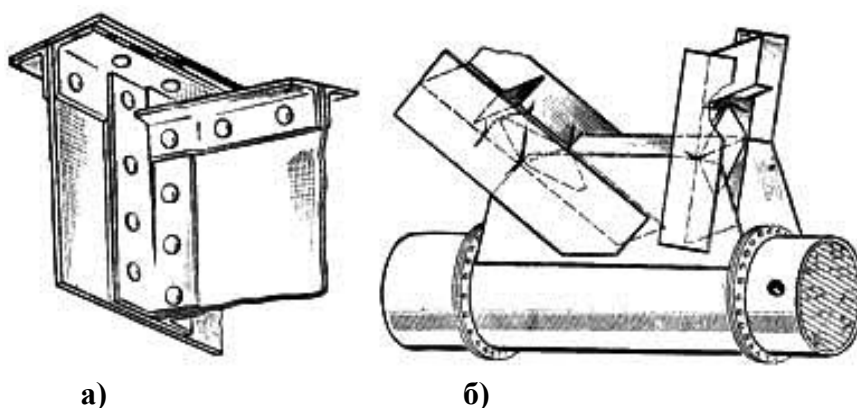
Трещины в уголках прикрепления балок к поперечным (а); характерные места появления продольных трещин в сварном узле (б)
